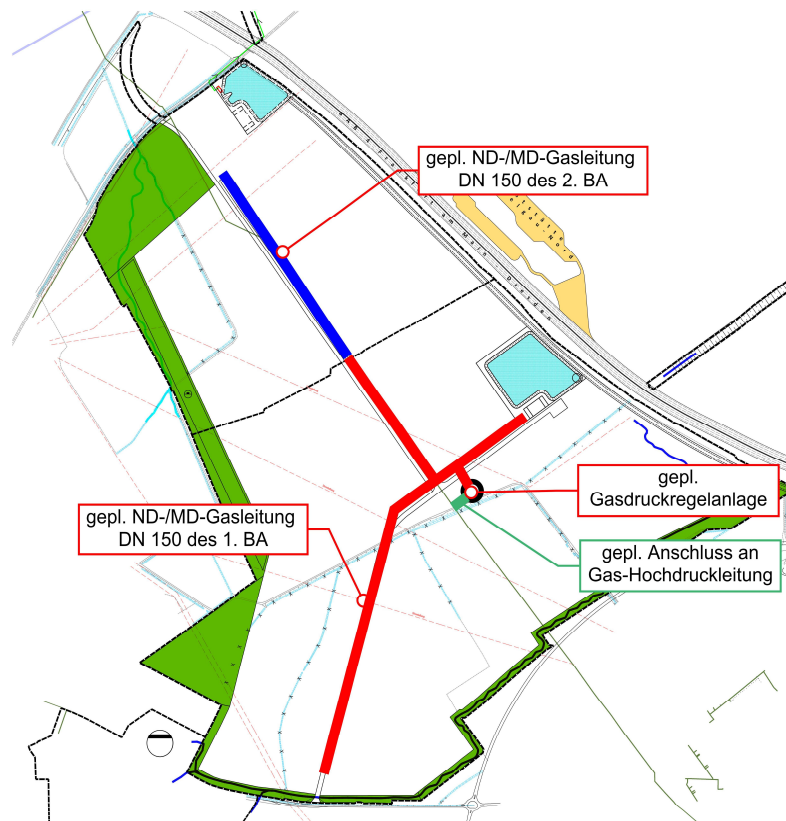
geplante Gasversorgungsanlagen des Erschließungsgebietes
